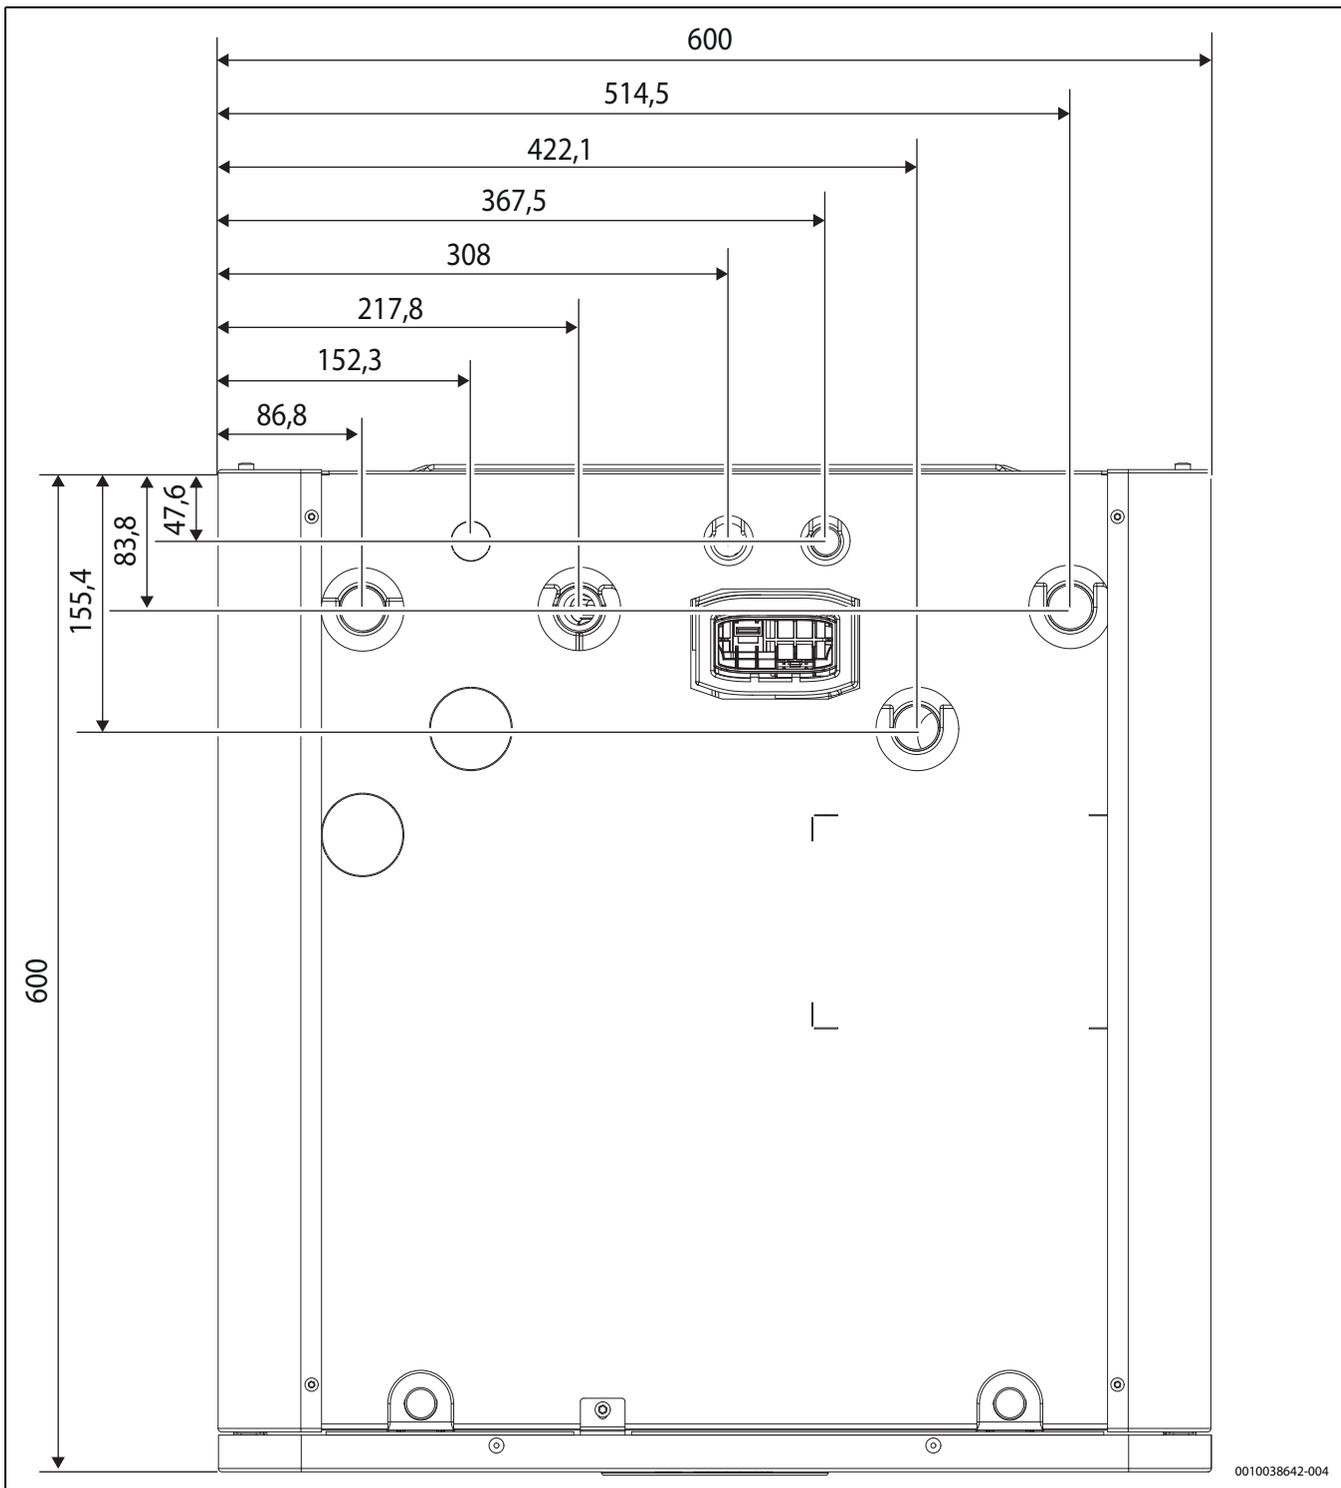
Dimensioni, collegamenti, vista dall'alto
